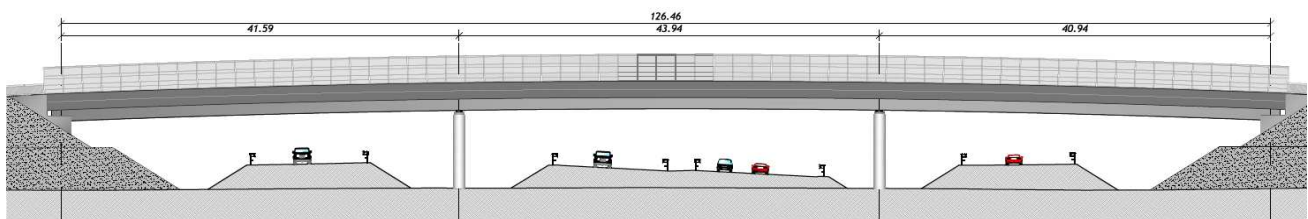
PROSPETTO CAVALCAVIA DI SVINCOLO
